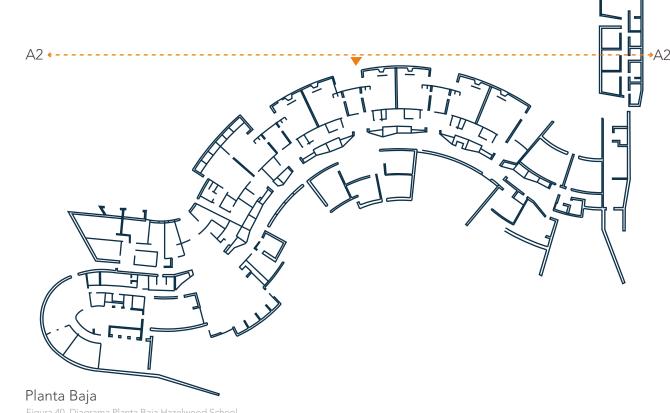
Diagrama Planta Baja Hazelwood School Fuente: Alan Dunlop Architects 2011. Adaptado por el autor 2023
